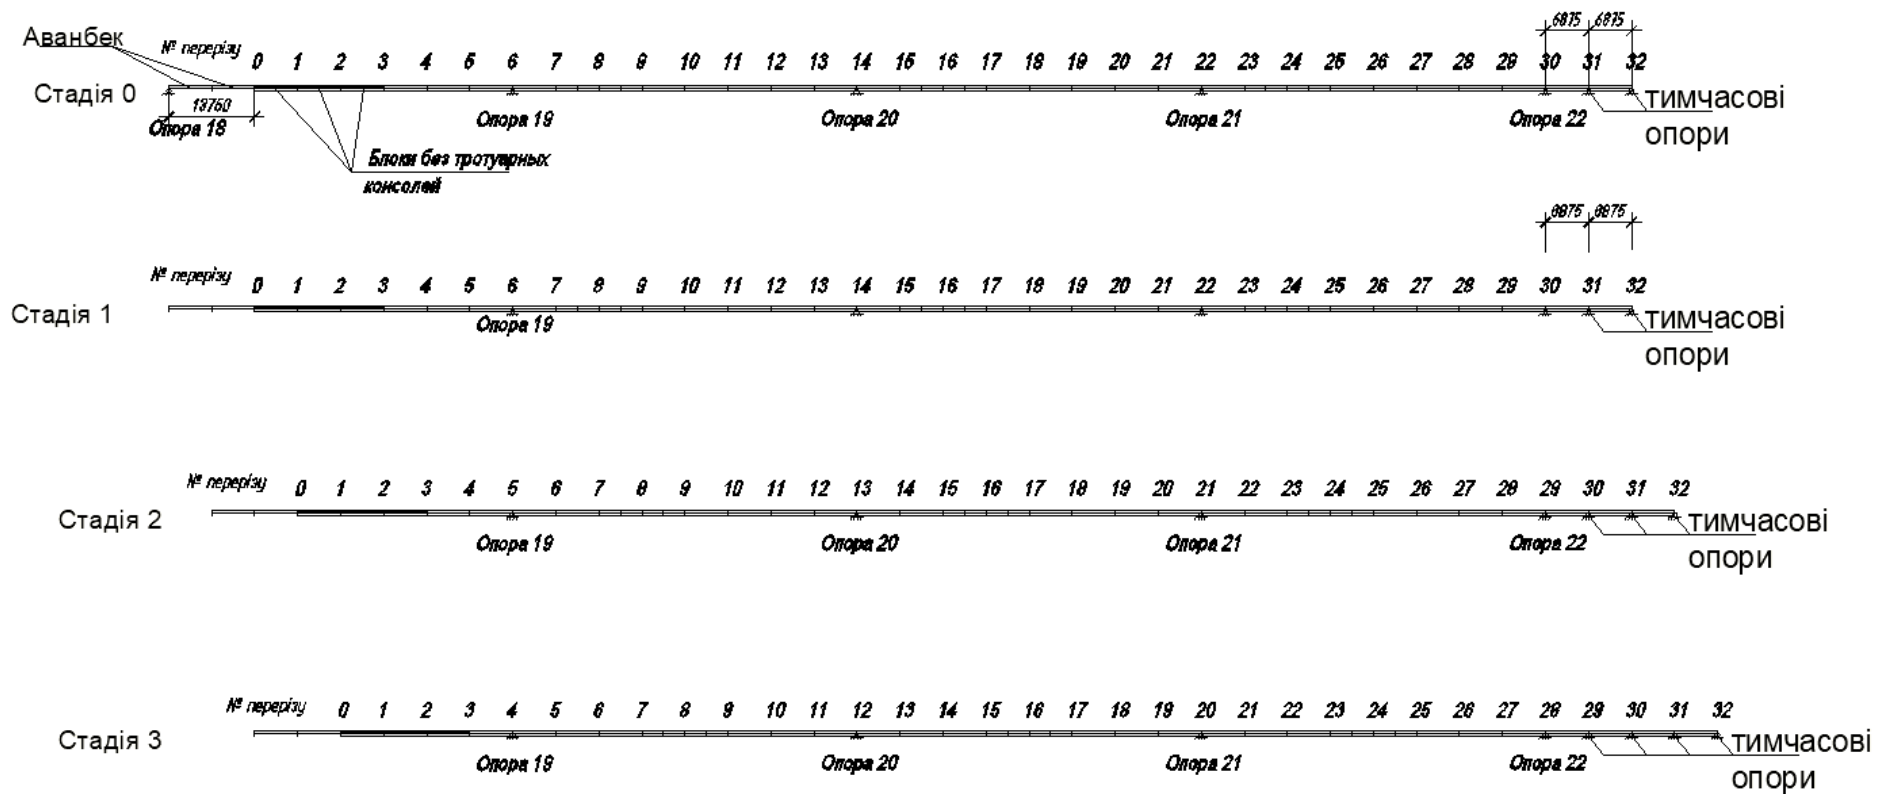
Розрахункові схеми стадій монтажу 0-3
